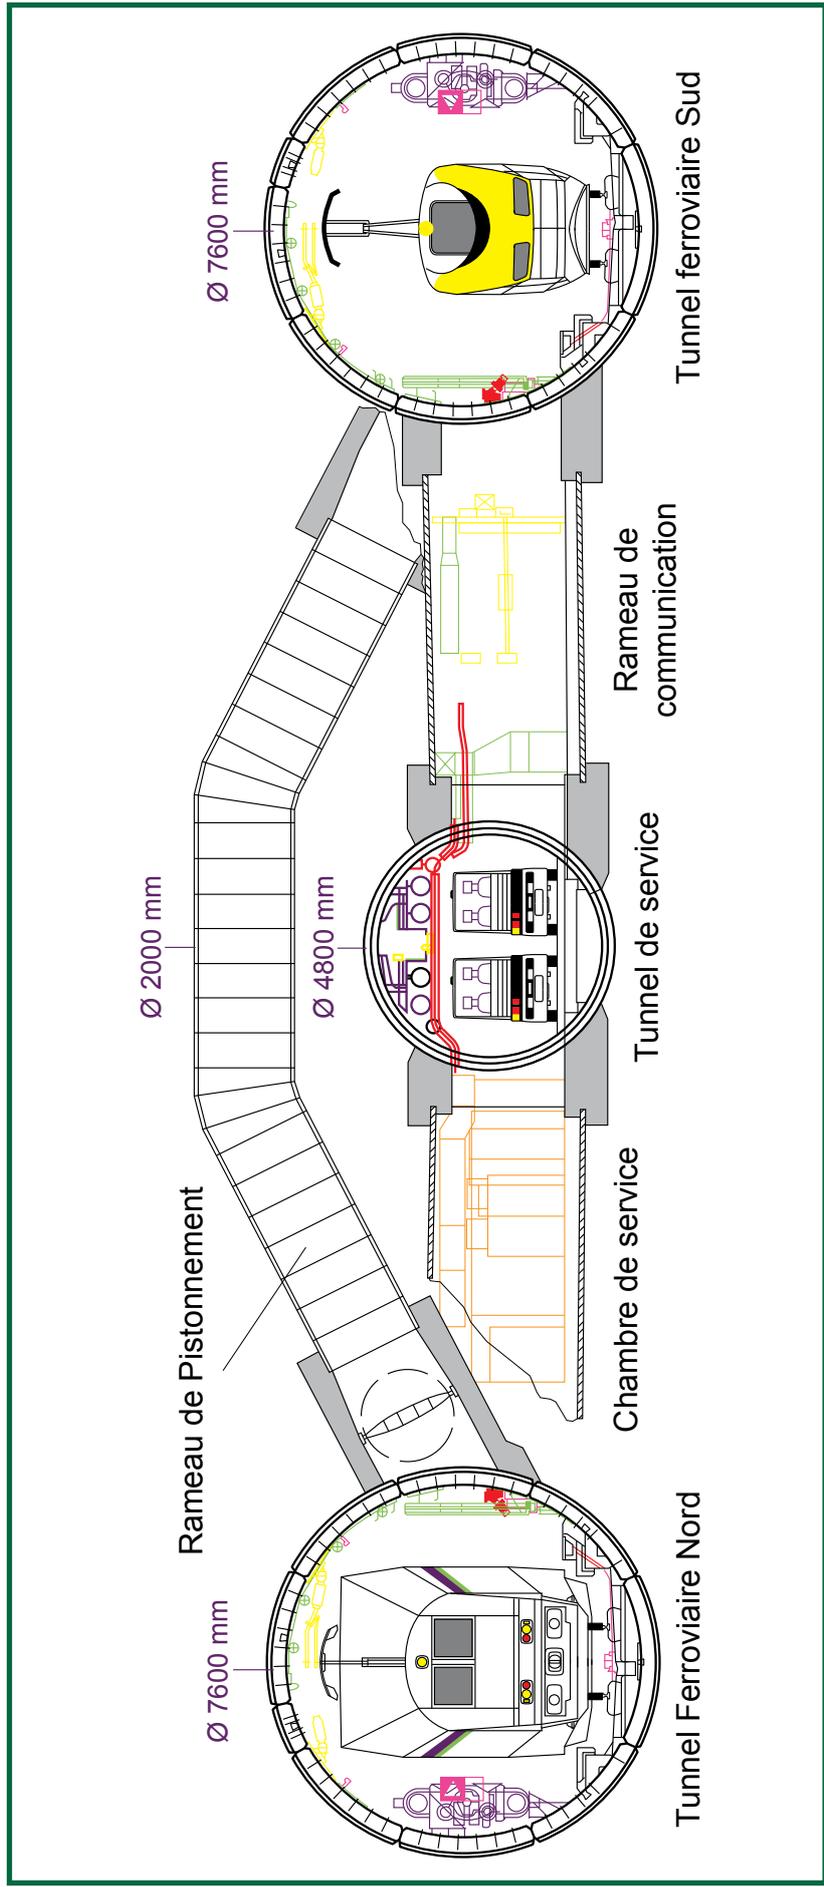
Vue en coupe montrant les deux tunnels ferroviaires et le tunnel de service
